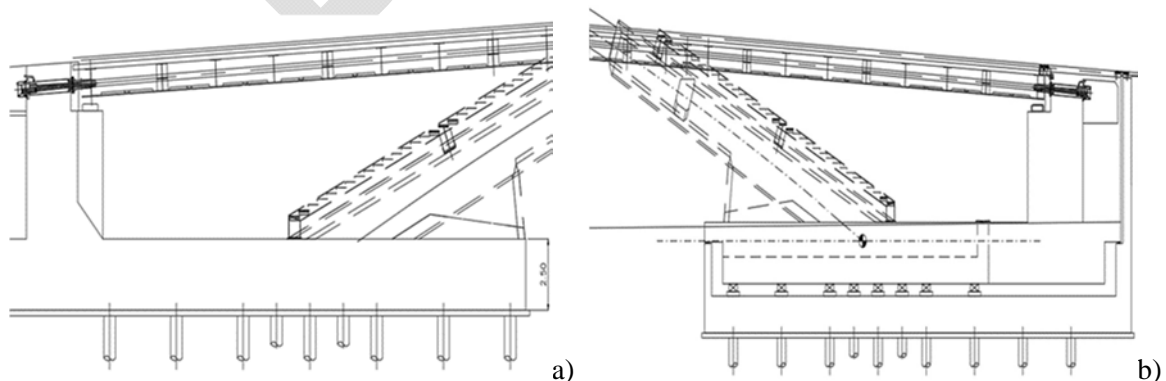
Vincoli alla base: a) spalla fissa sul lato Ovest b) spalla mobile sul lato Est (Ing. G. Stroveglia).
